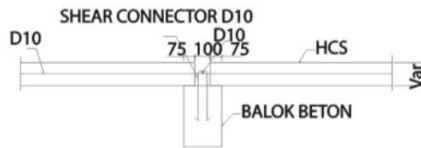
Peletakan Pelat Precast Hollow Core Slab
